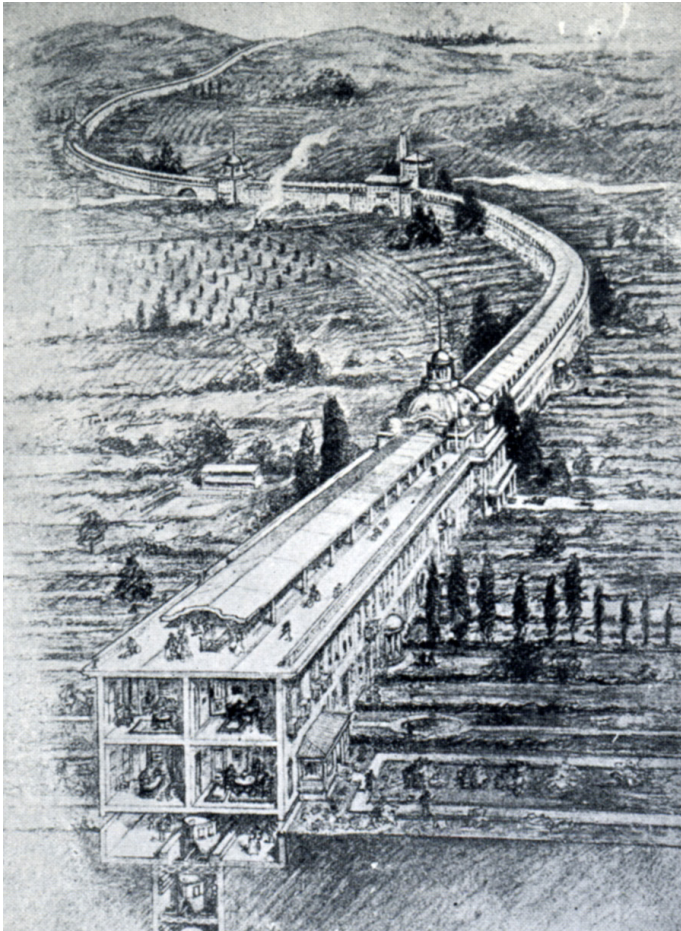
\_ EDGAR CHAMBLESS. ROADTOWN. 1910.
